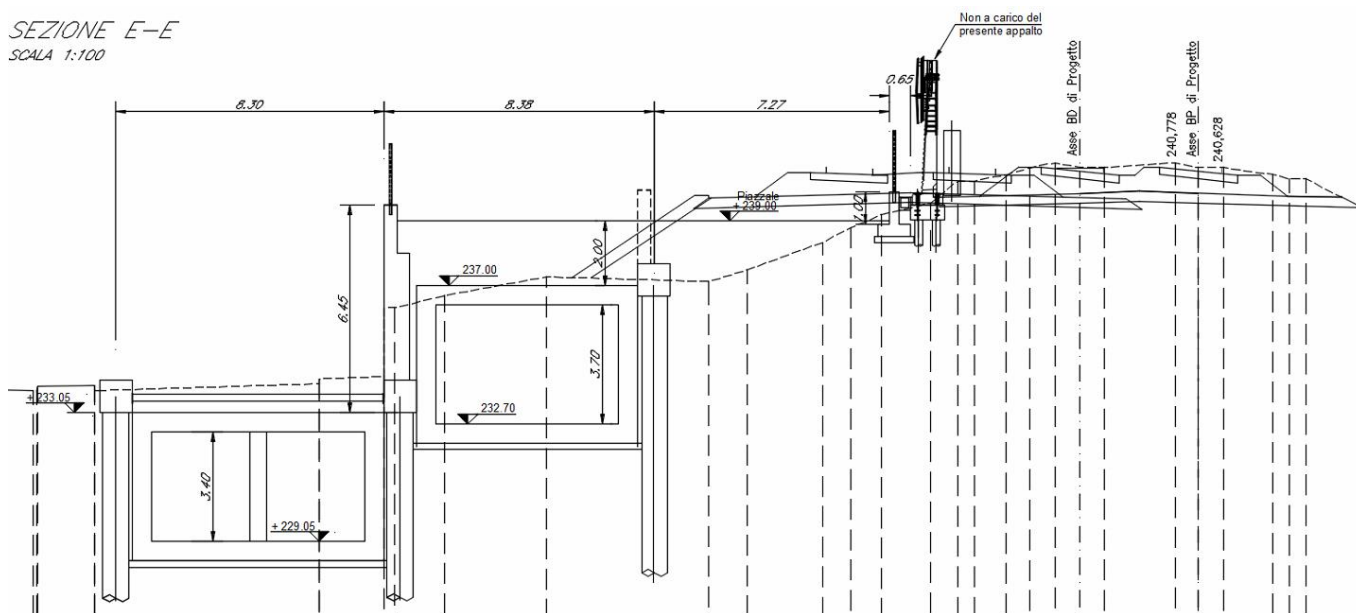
Sezione trasversale Piazzale e vasca di laminazione
